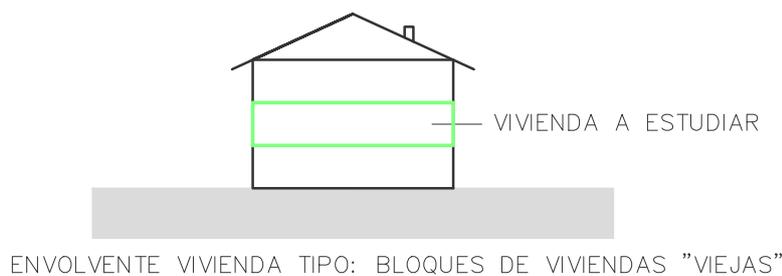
, Envoltente. Vivienda tipo: Bloques de viviendas “viejas”
